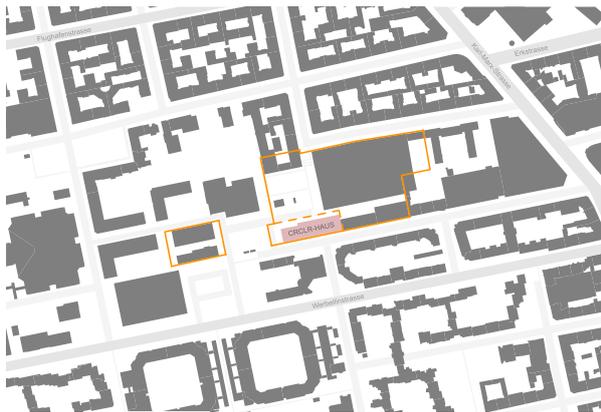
Lageplan CRCLR Haus in Berlin-Neukölln
